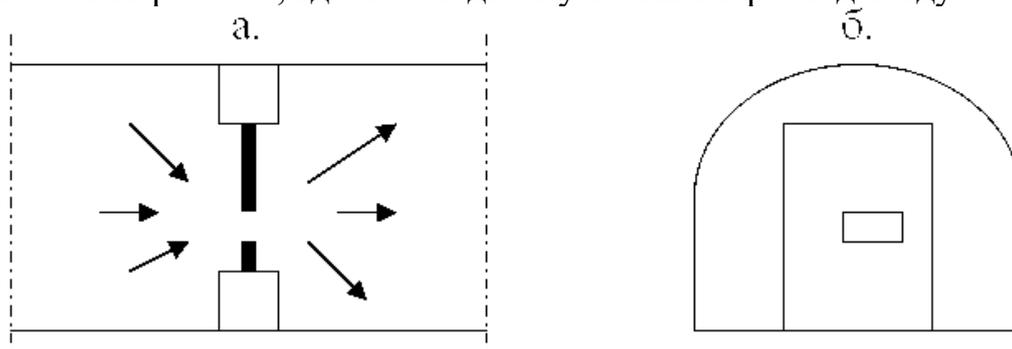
Вентиляционное окно в продольном (а) и поперечном (б) сечении выработки
